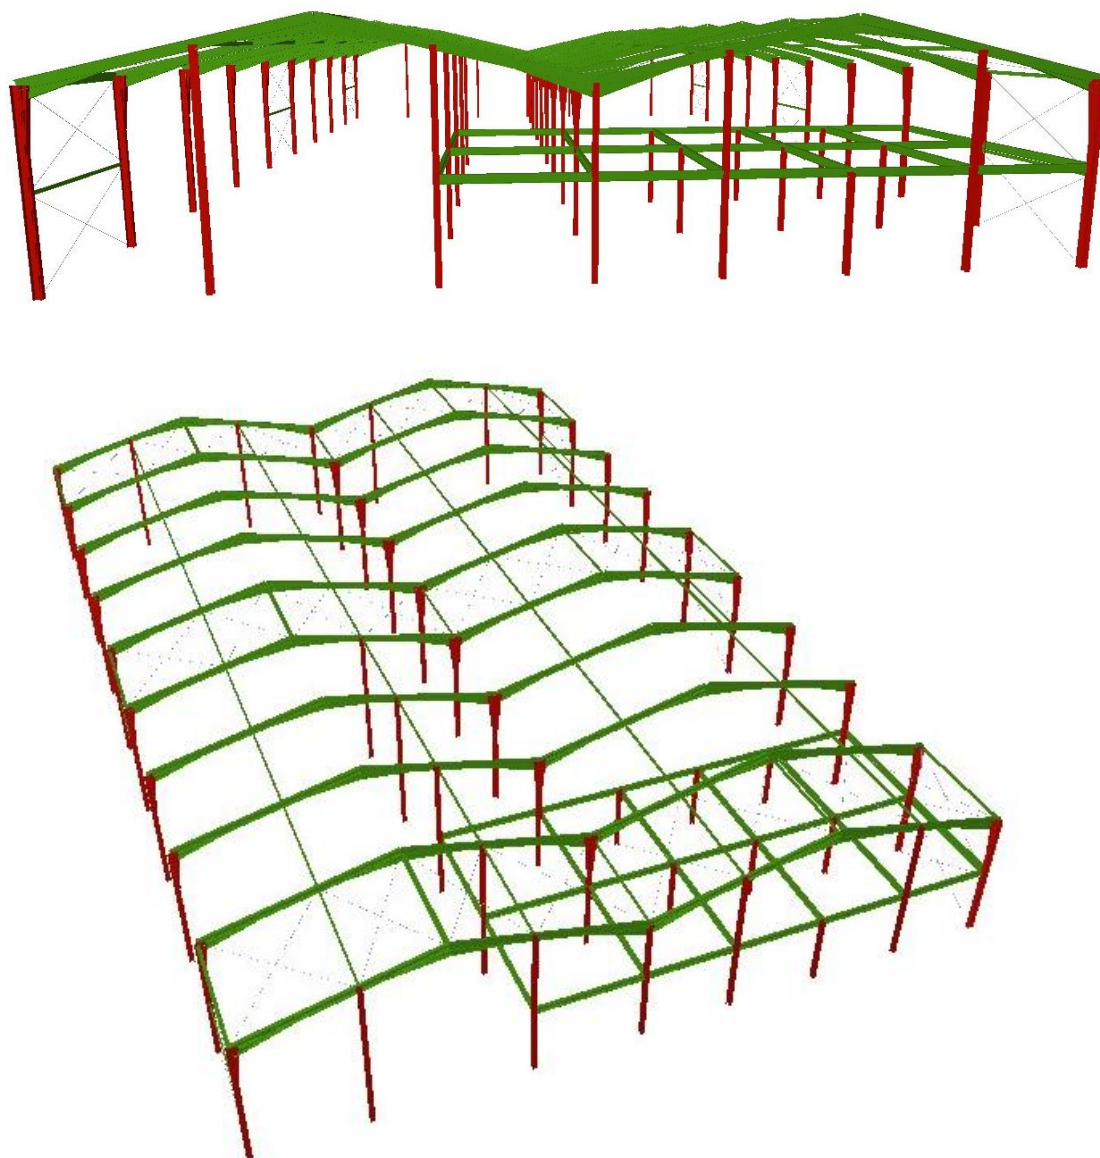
Vistas de la estructura metálica de la nave (fuente: CYPE ingenieros)
